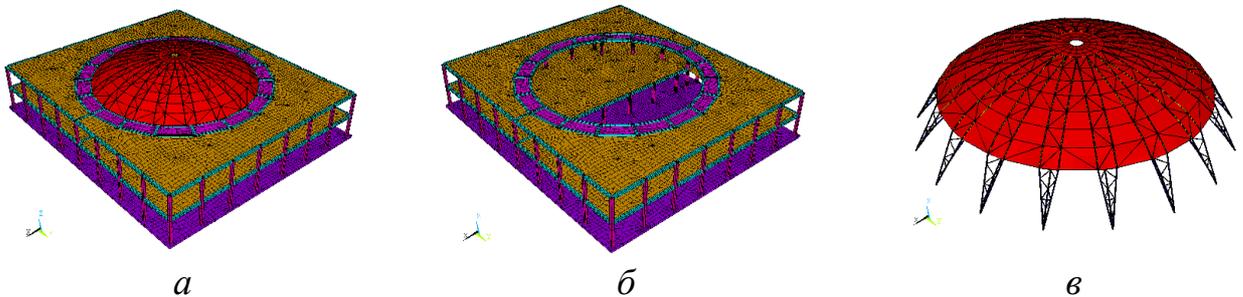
Разработанные расчетные КЭ-модели несущих конструкций входного блока гипермаркета «ВолгаМолл» в г. Волжский. а) «железобетонные конструкции каркаса – металлические конструкции покрытия»; б) «железобетонные конструкции каркаса»; в) «металлические конструкции покрытия»
